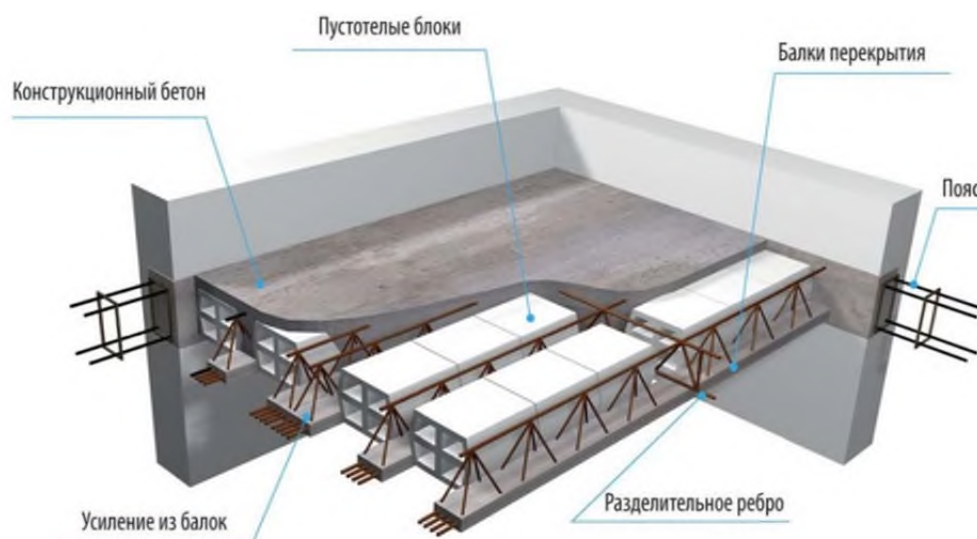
Сборно-монолитное перекрытие «ДАХ»
